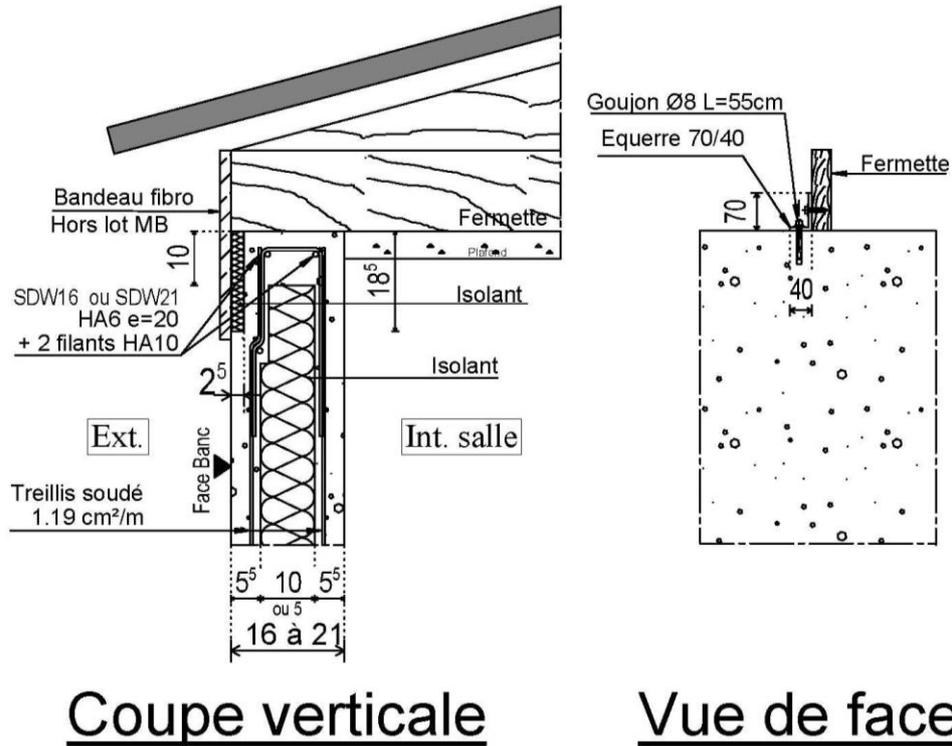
Panneaux sandwichs de façade non porteurs posés sur soubassement – Détail tête de mur – variante 2
